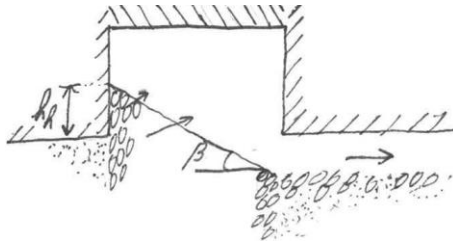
Uitspoeling van bovendeeel barrière aansluitend op benedenstroomse pipe tot ongeveer een hellingshoek gelijk aan de hoek van inwendige wrijving. De geschetste situatie betreft een relatief brede barrière met een relatief lage inkassing (zijaanzicht met enige 3D-suggestie in langsricting).
